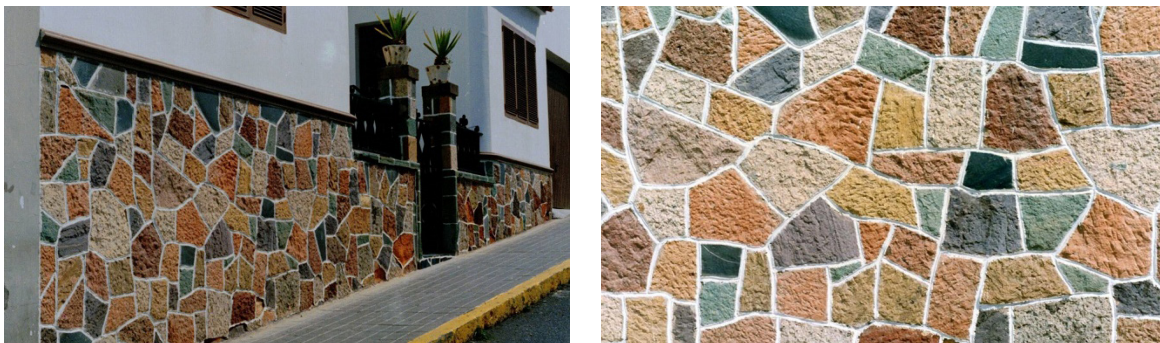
Fachada en Arucas (el zócalo utiliza "recortes" de los talleres de piedra). Fotos realizadas en 2010.
